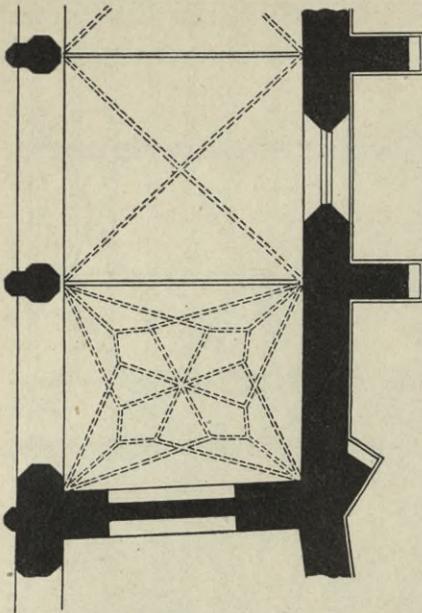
Dom St. Peter, Grundriß des Singechors.
